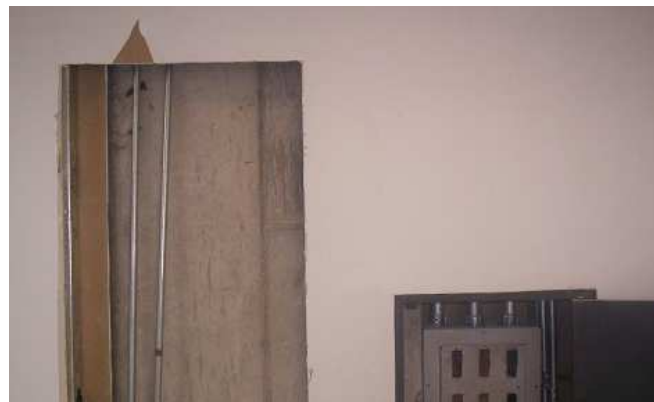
Panorama inicial de las paredes del sexto piso.
